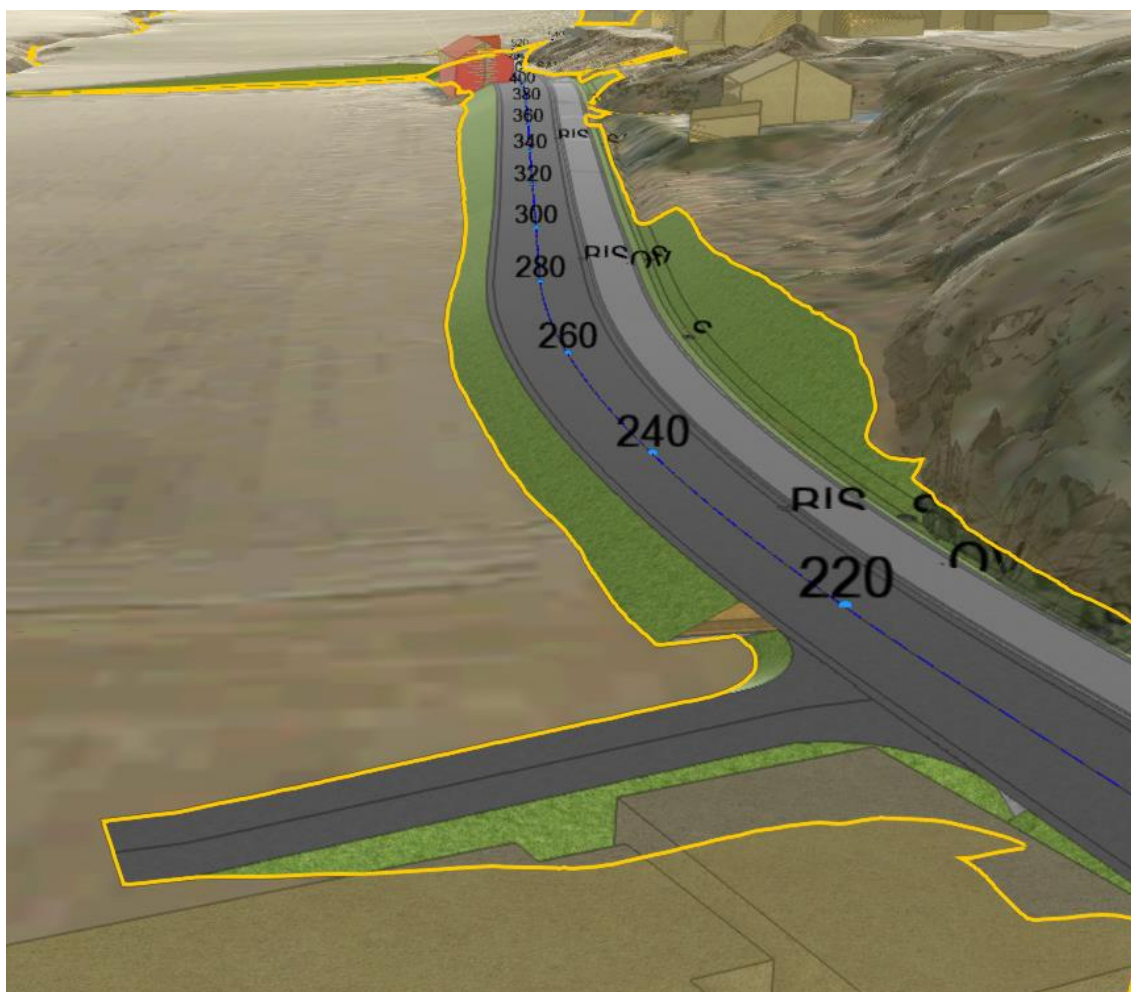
Profil 150-500. Kilde: Asplan Viak AS
